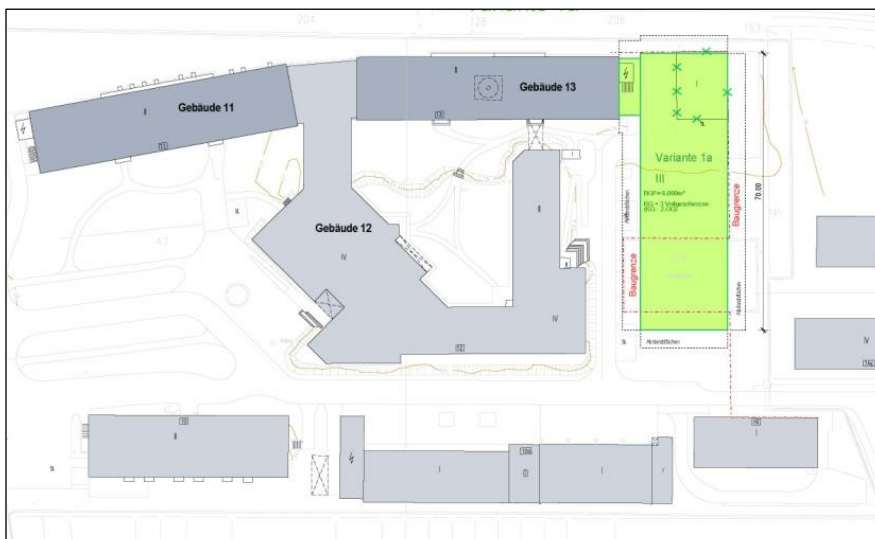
Lageplan Neubau und Gebäude 11 und 13
